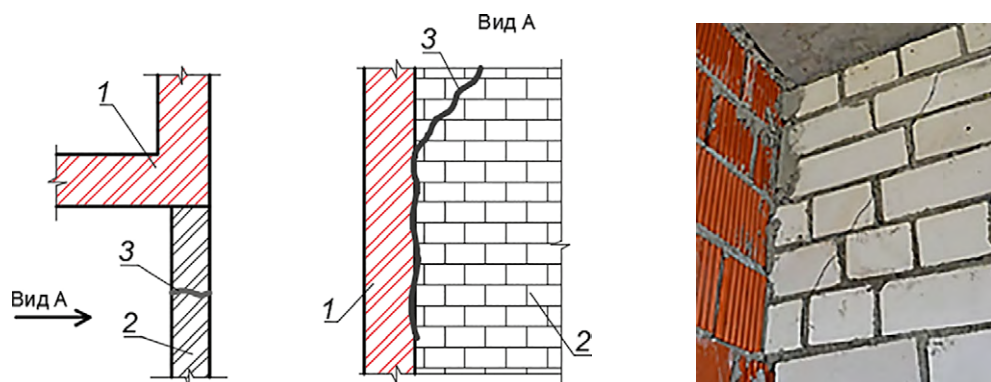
Трещина во внутренней стене из силикатного кирпича на пересечении с наружной стеной из керамического камня: 1 – наружная стена из керамического камня; 2 – внутренняя стена из силикатного кирпича; 3 – сквозная трещина внутренней стены
